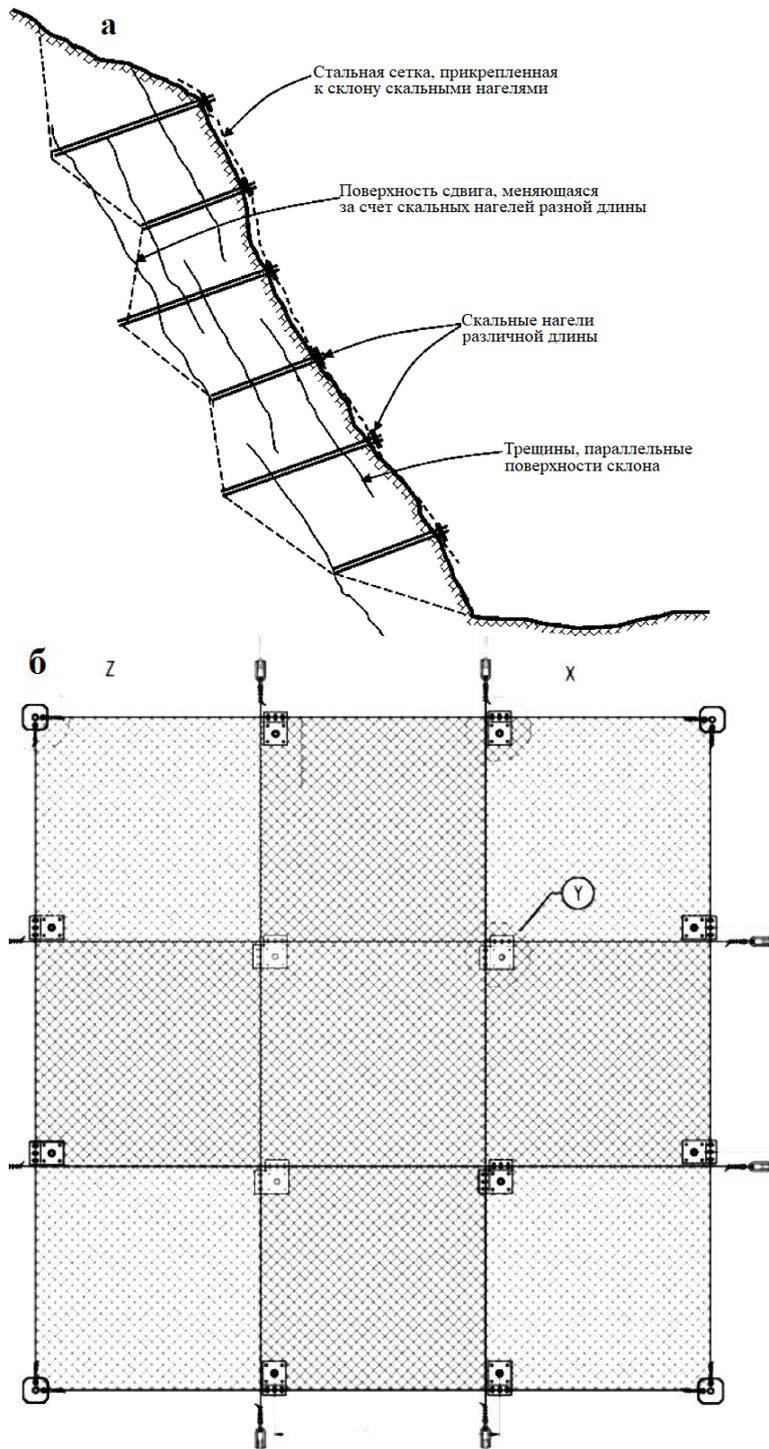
Система стабилизации неустойчивых блоков на склоне с помощью гибкой стальной сетки, прикрепленной к массиву пород скальными нагелями или грунтовыми анкерами: а – в разрезе; б – в плане (по [3])
